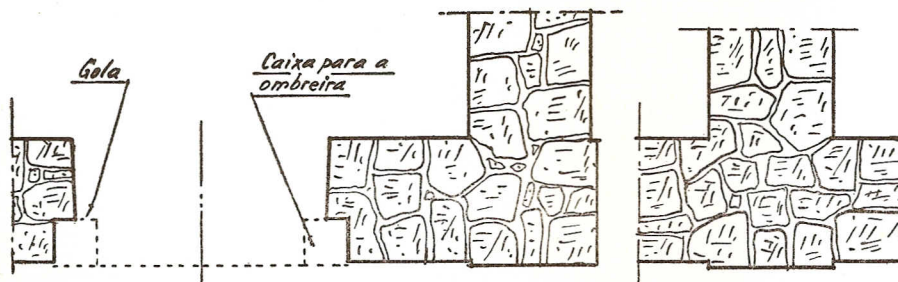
PAREDES DE ALVENARIA DE PEDRA
